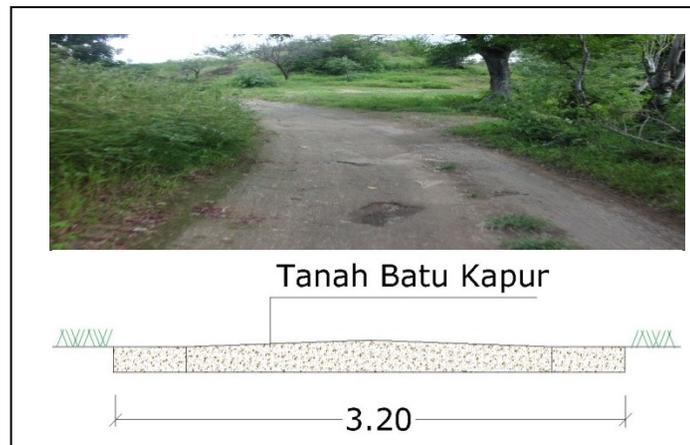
foto dan sket profil bk2 tanah batu kapur baik
